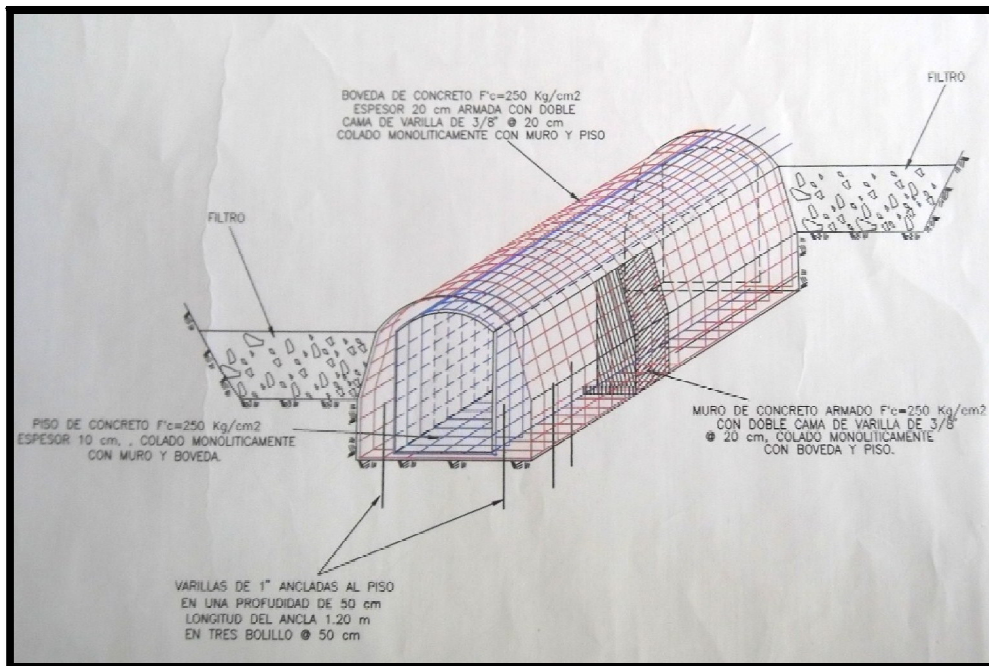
Sistema decantador drenante existente (imágenes proporcionadas por el departamento de Planeación de Minera La Negra)
